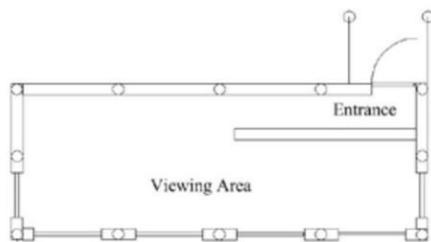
Planta B, Con entrada trasera y que regula la entrada de luz
